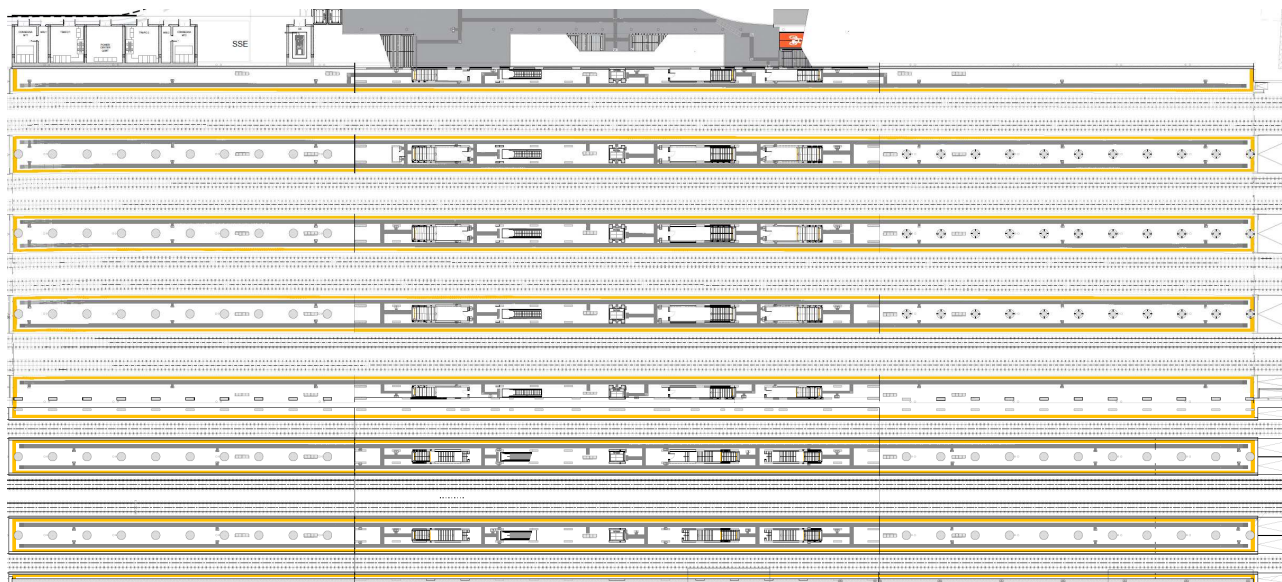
Pianta Piano Banchine e cabina di stazione.
